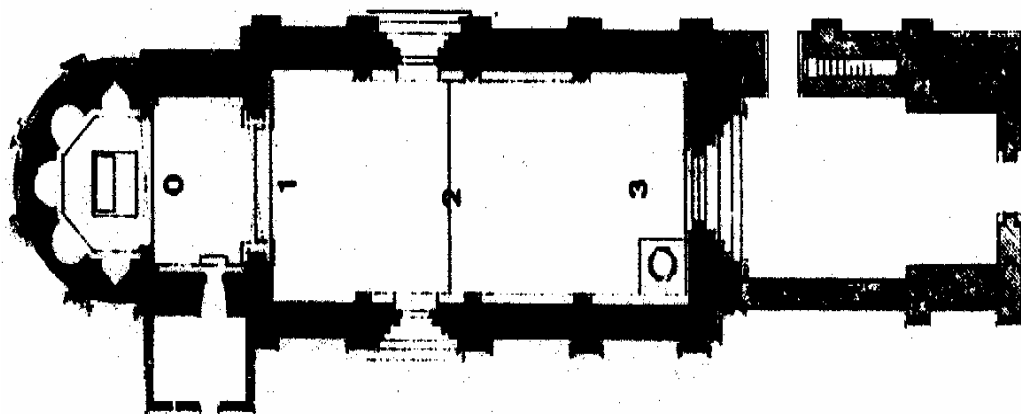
Planta da igreja de São Pedro de Ferreira [3]
